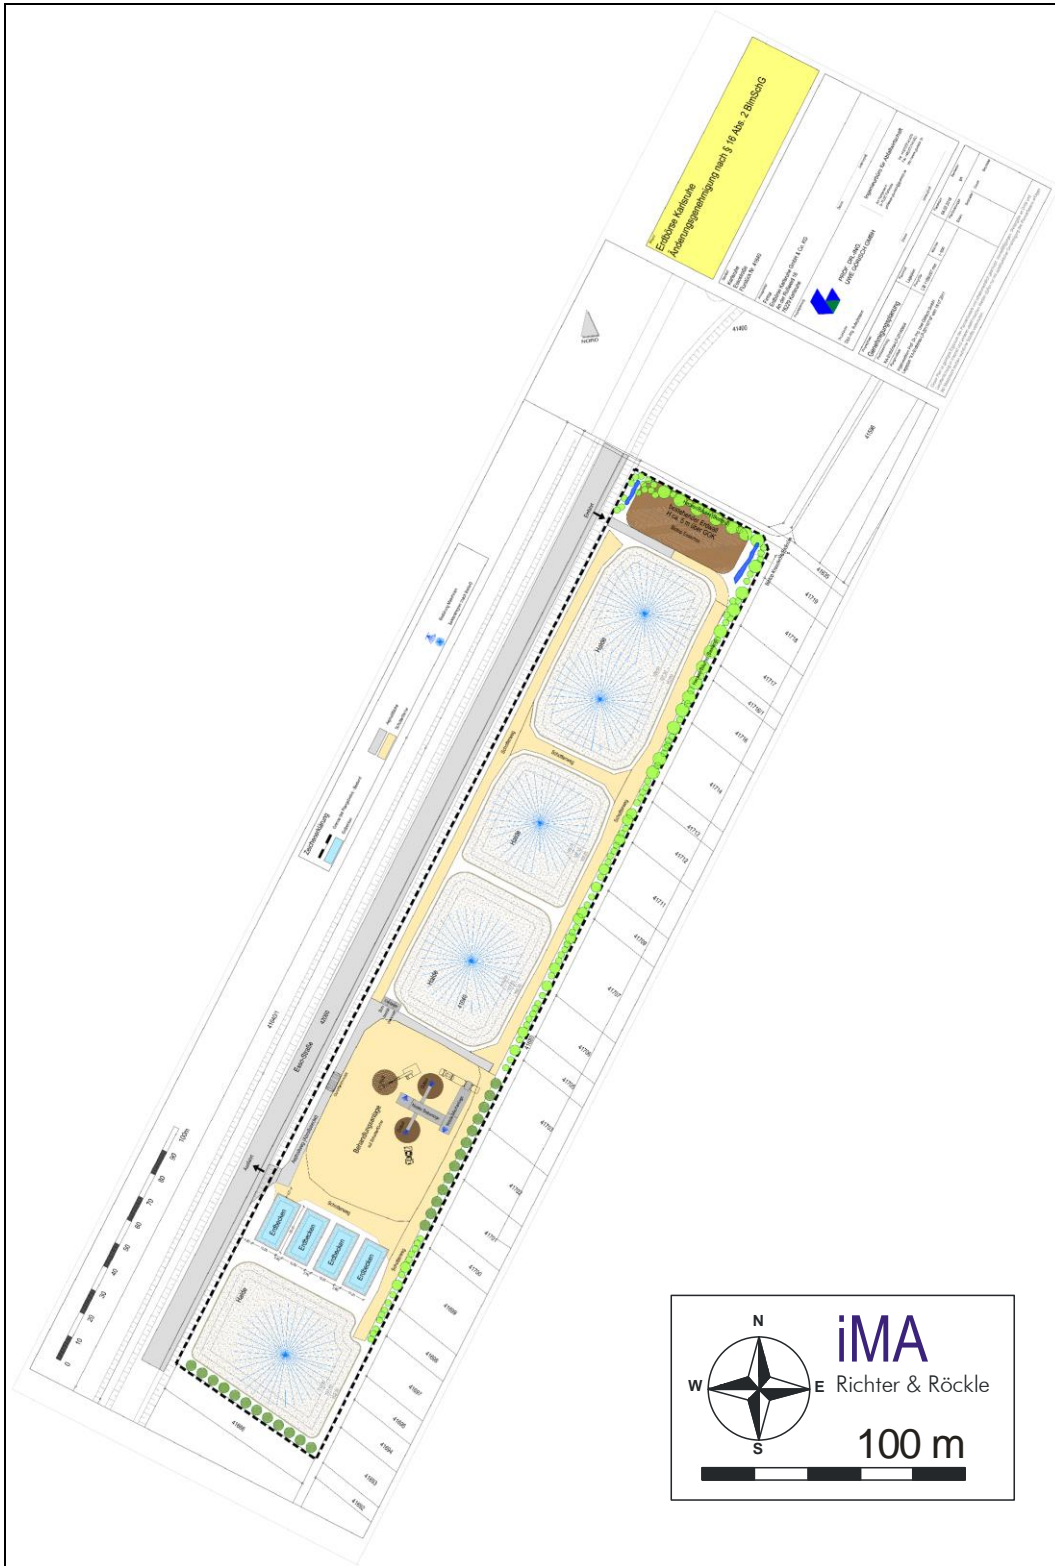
Lageplan des Betriebsgeländes. Die Erdbecken (blau) befinden sich im südwestlichen Bereich des Geländes (Plan: Ing.-Büro Prof. Dr. Uwe Görisch GmbH)
